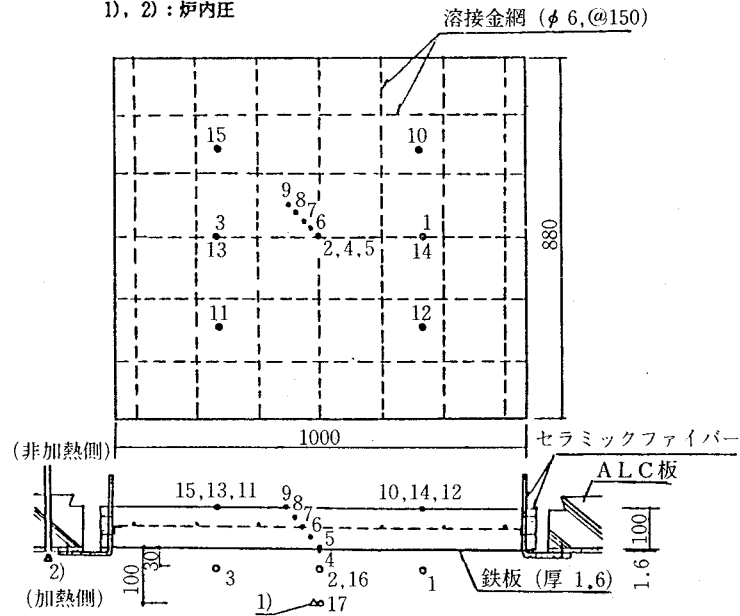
試験体の形状及び温度測定位置 (寸法単位 : mm)
